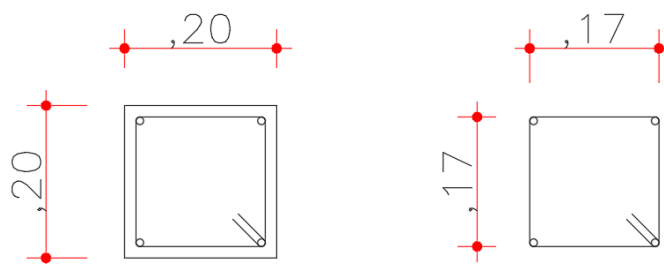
Detalhe técnico, seção das vigas e armaduras.
